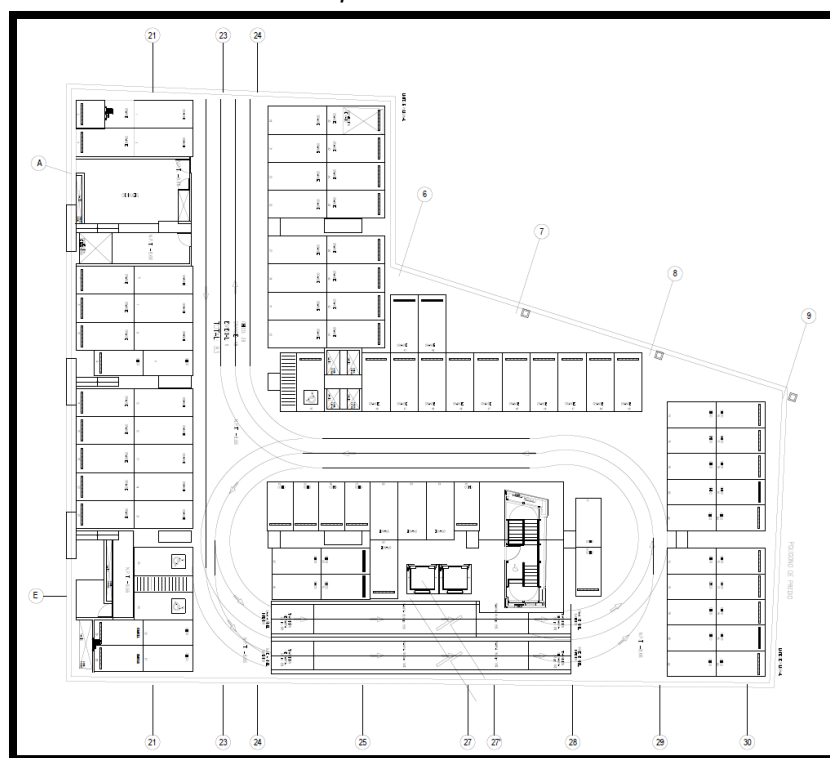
Planta arquitectónica niveles Sótano 1 y Sótano 2
